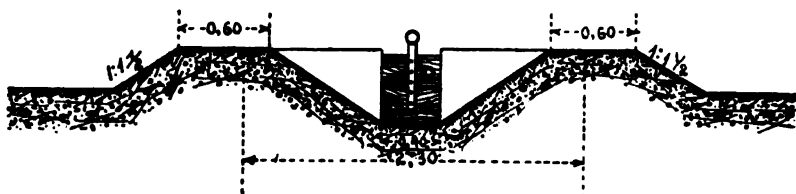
Baraj de beton pentru canalele mici de irigațiune.
